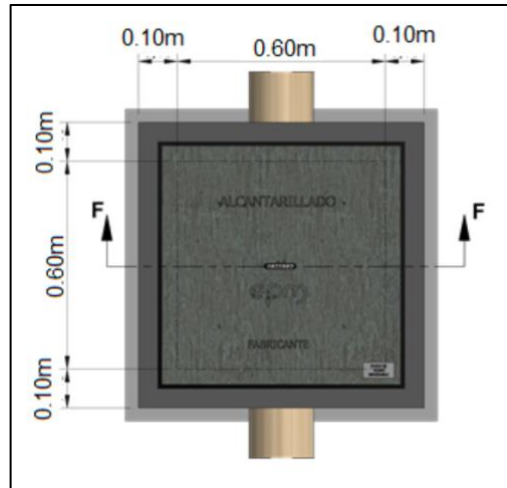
Caja de inspección – Vista en planta. Fuente. EPM, 2019.
